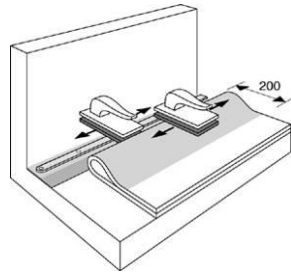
Bande de fixation d'embase, QuickSeam Reinforced Perimeter Fastening Strip
